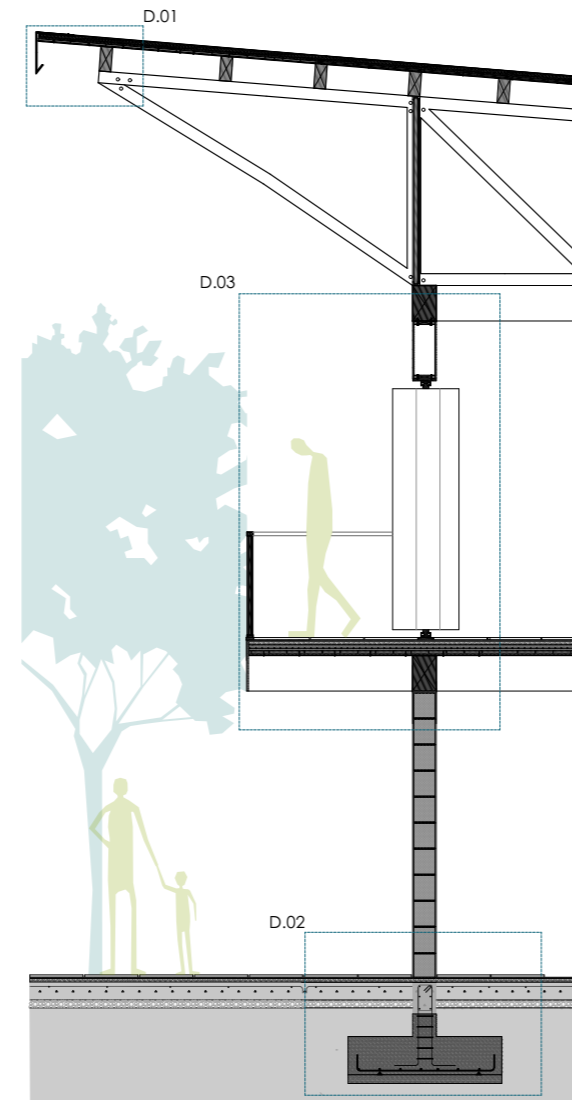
Sección constructiva bloque A. Fuente: Elaboración propia.
